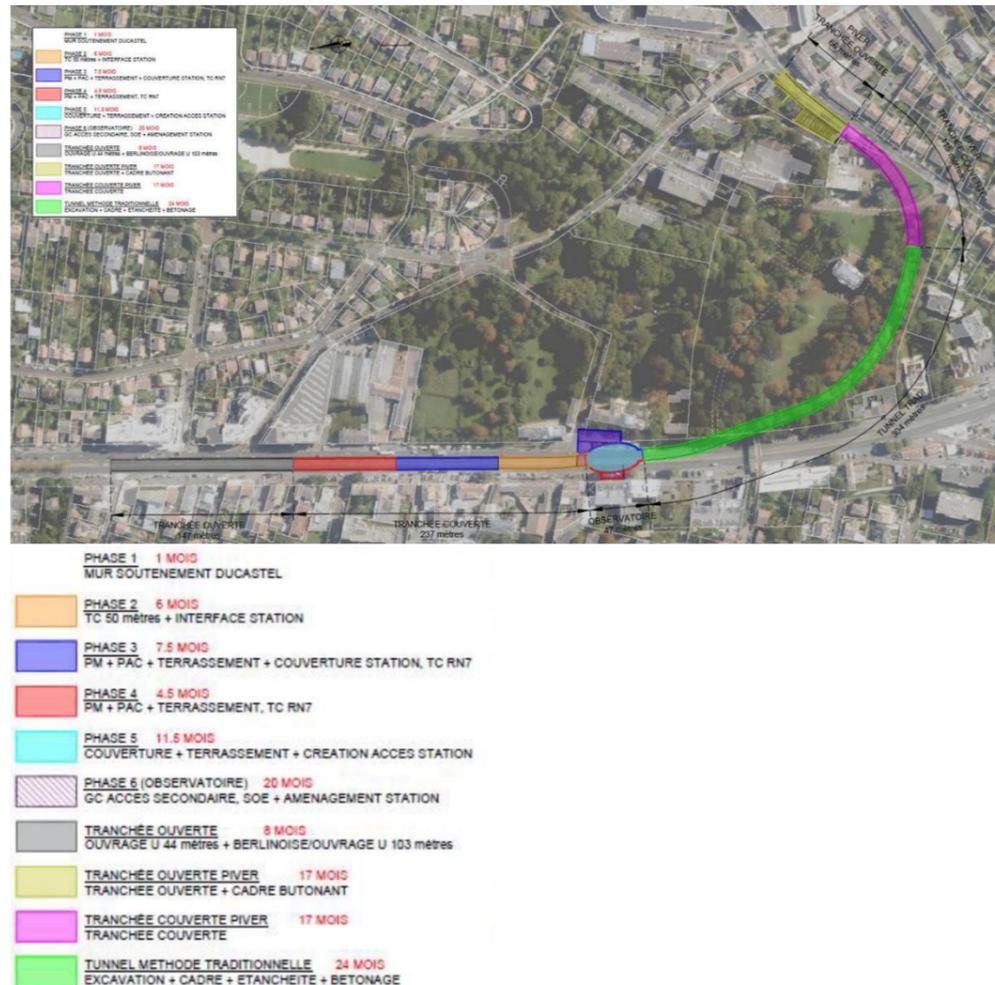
La section enterrée. Source : PRO du prolongement du T7, décembre 2018
